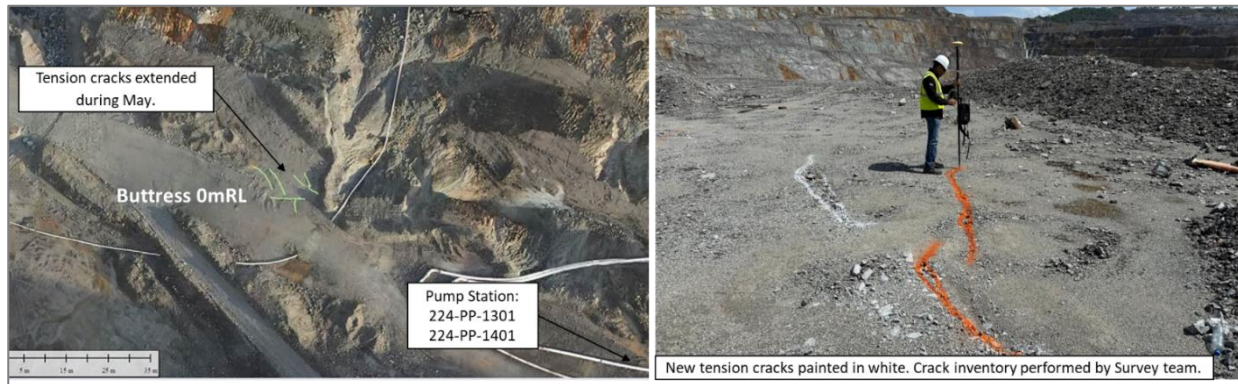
Extensión de grietas existentes y aparición de nuevas grietas, durante mayo de 2026 < > Levantamiento de grietas generado por el Departamento de Topografía de Mina.
